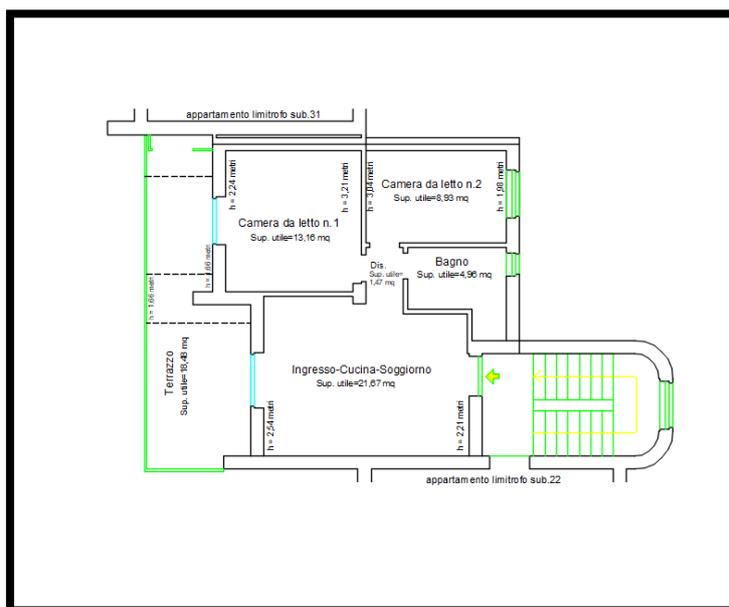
Rilievo appartamento part. 672 sub 21 – Piano terzo
